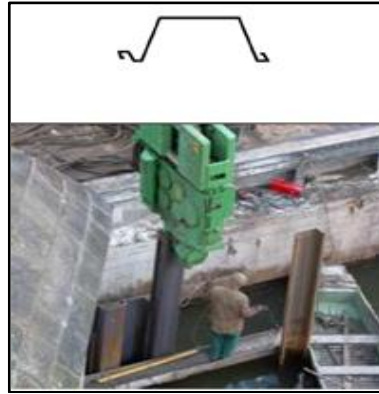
Palplanches pour la consolidation des ouvrages
